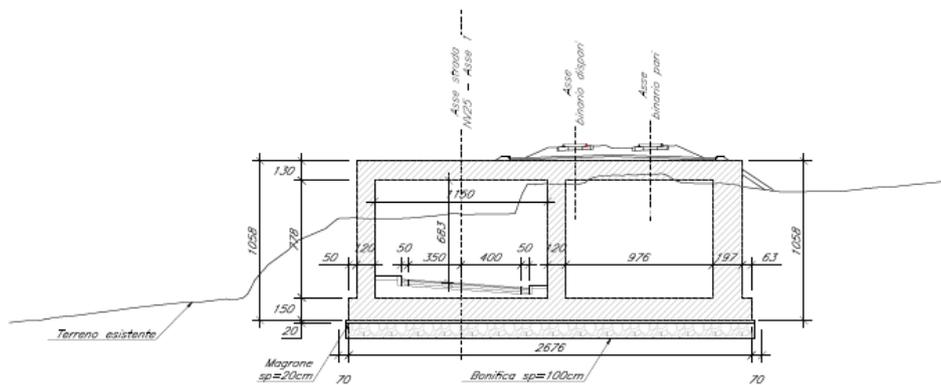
SL25 – Sezione trasversale in asse ferrovia
